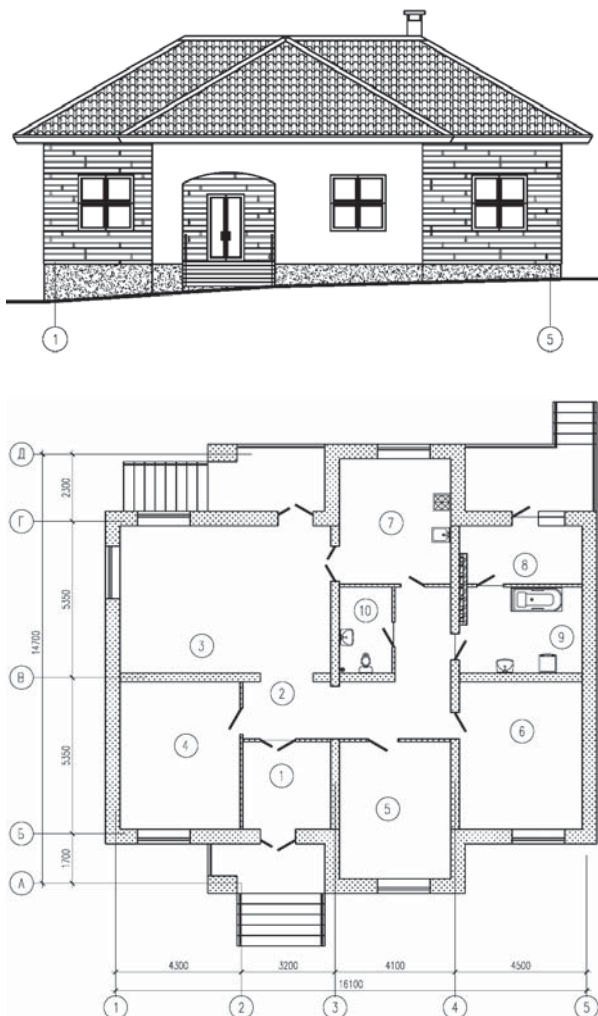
Фасад и план экспериментального полносборного жилого дома из армированных ячеистобетонных изделий
